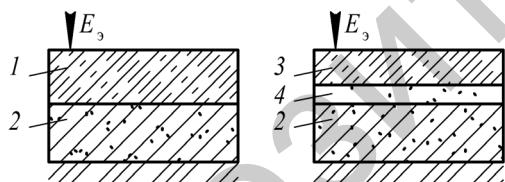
Конструкции оснований под жесткие покрытия с применением грунта, укрепленного цементом:
